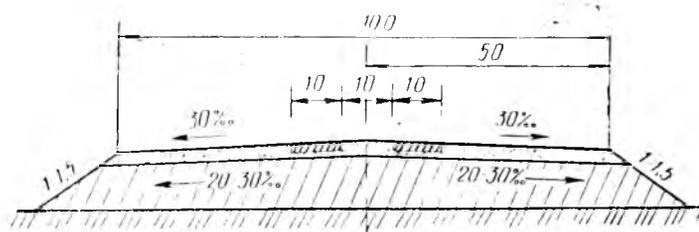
Поперечный профиль равнопрочной двухполосной дороги с колеиным железобетонным покрытием
